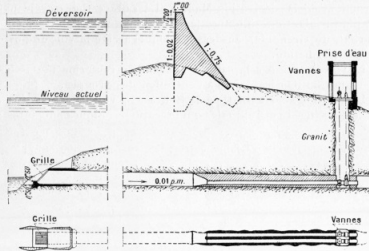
et 12. — Coupe verticale et plan d'un barrage et d'un ouvrage de prise d'eau secondaire.
